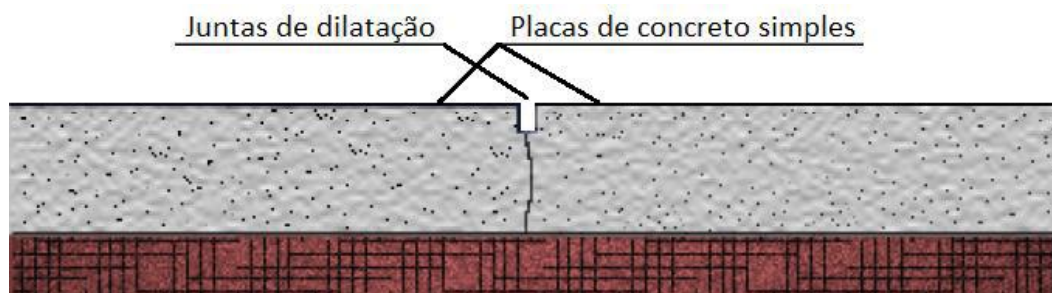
Perfil de Pavimento rígido de concreto simples, sem barras de transferência.
